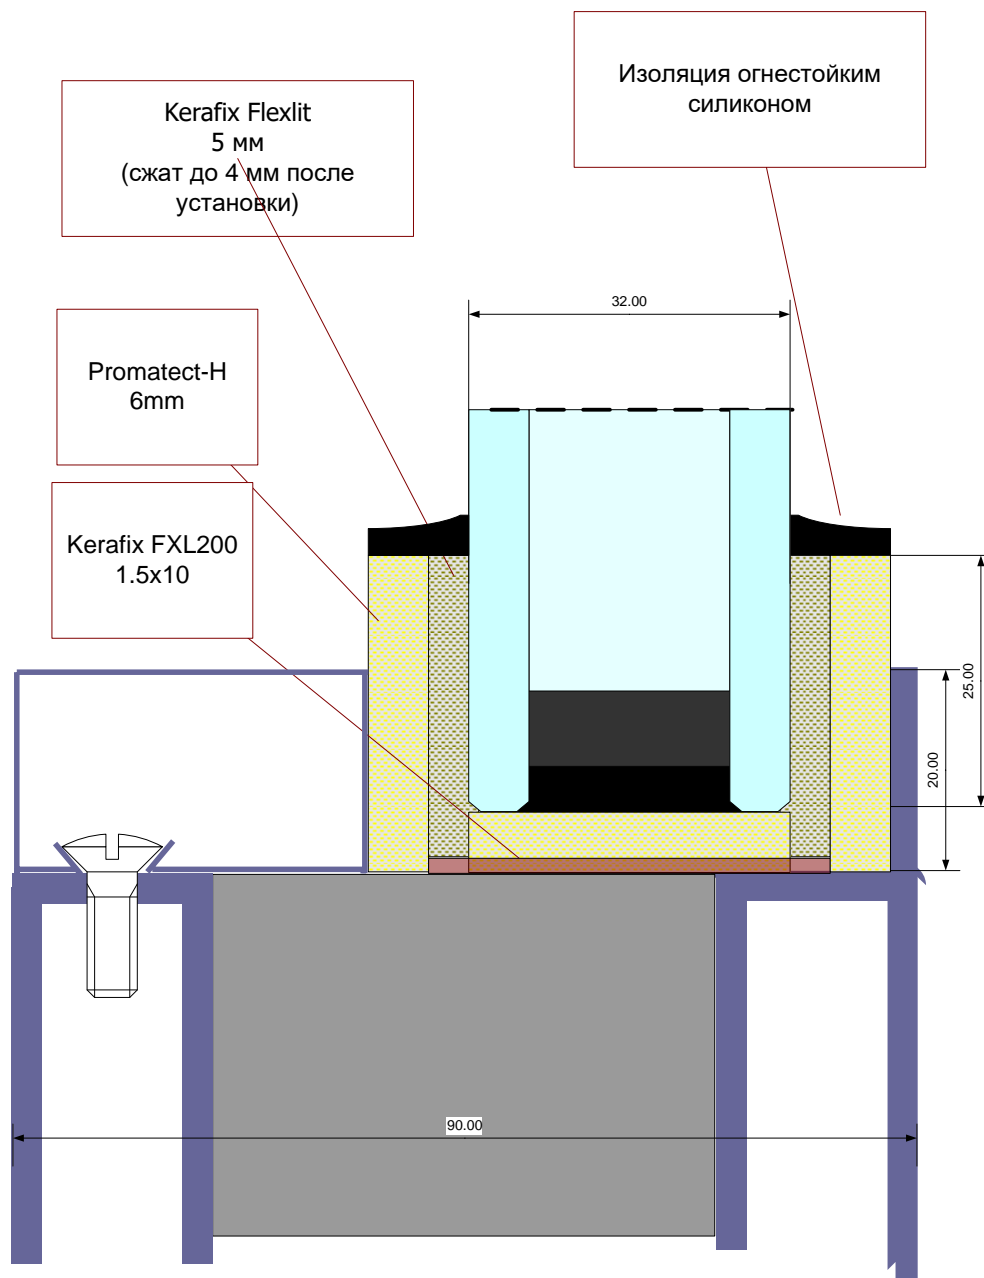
Пример монтажа стекла в стальную огнестойкую конструкцию класса EI60 с внутренним тепловым разрывом (система Stalprofil). В случае, когда стальной профиль не обеспечивает перекрытие кромки стекла на заданное расстояние используется дополнительная жесткая теплоизоляция из материала Promatect. Использование материала Coolmax позволяет обойтись без перекрытия высоты профиля.
